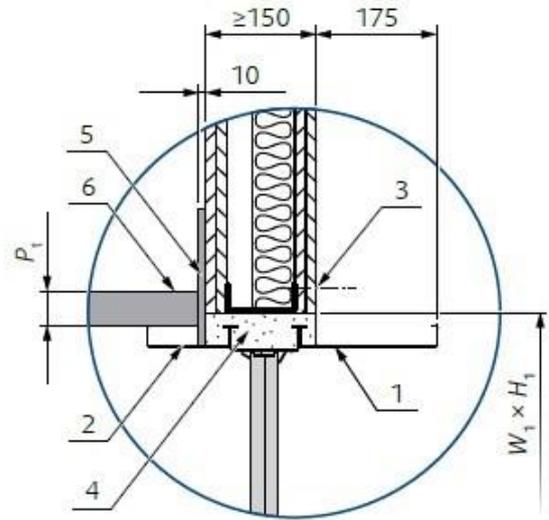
(EI120S) Sezione trasversale di ① Installazione umida in parete flessibile
